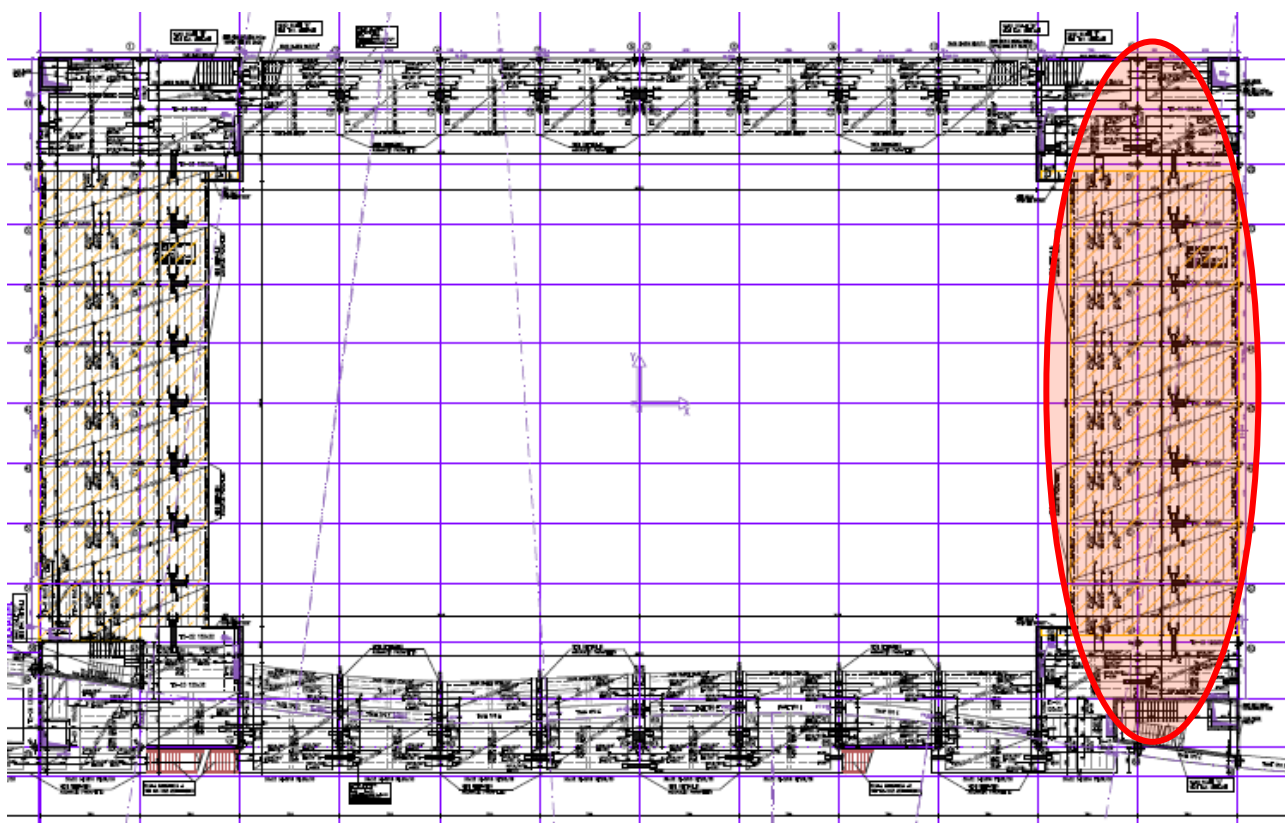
Strutture oggetto di intervento - Pianta secondo solaio
